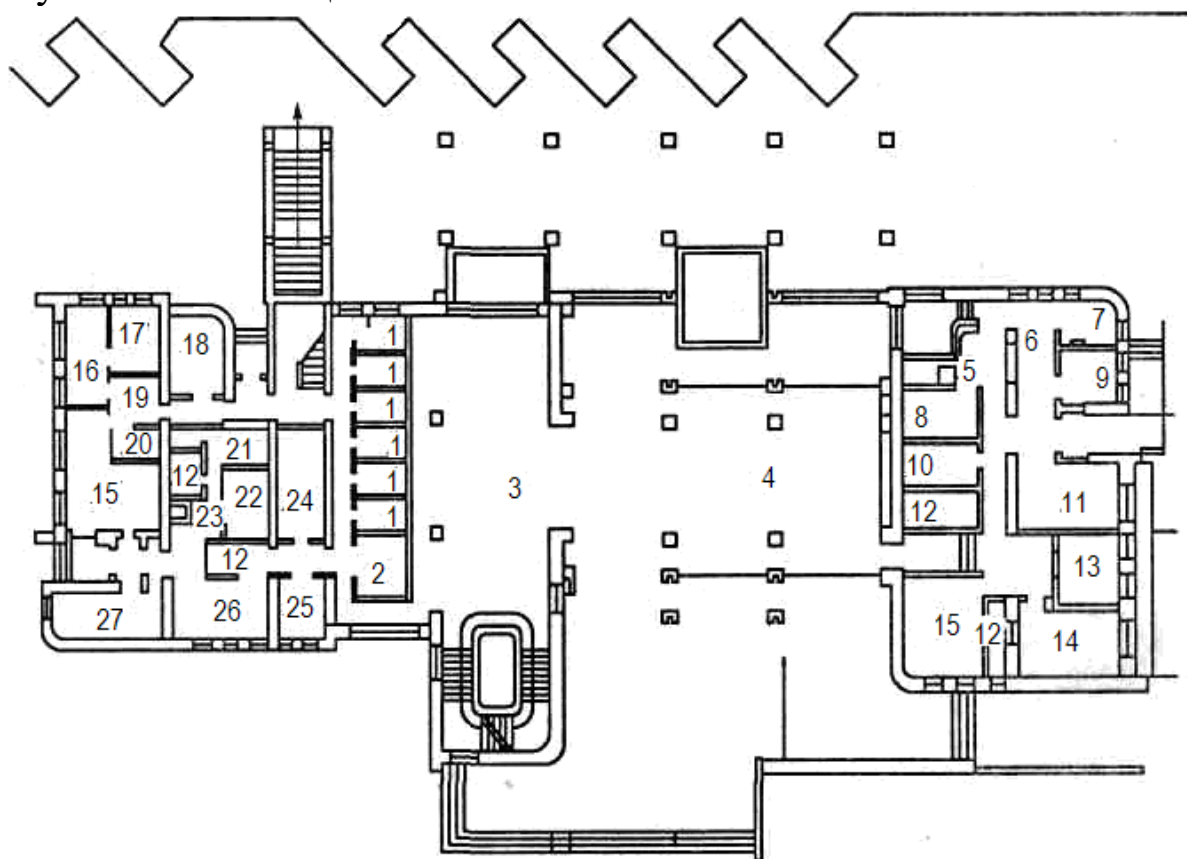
Планировка первого этажа здания автовокзала:
